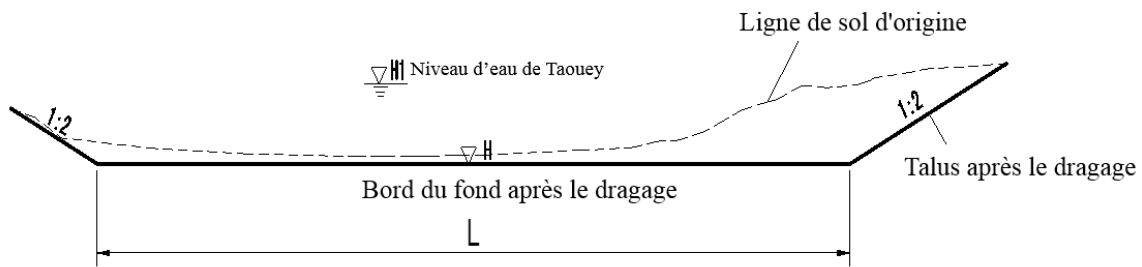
Coupe typique de l'expansion du Canal de la Taouey
